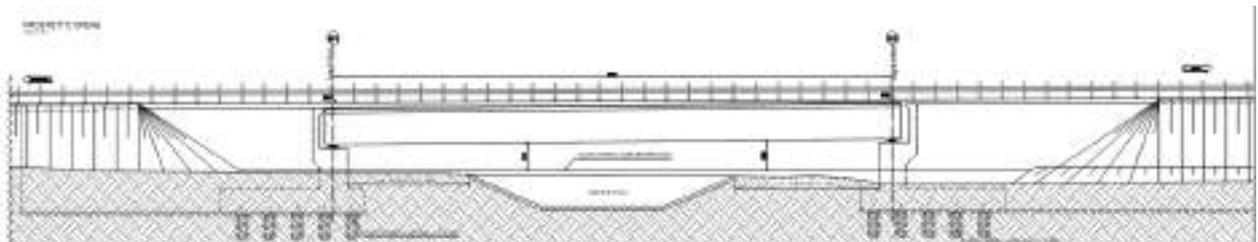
Prospetto del Ponte scavalco deviazione canale embioi alla prog. 7+814.00.
